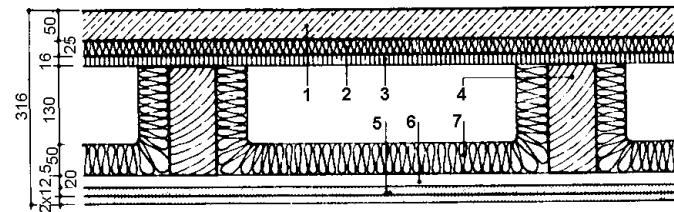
Деревянные балочные перекрытия. Вариант V.
